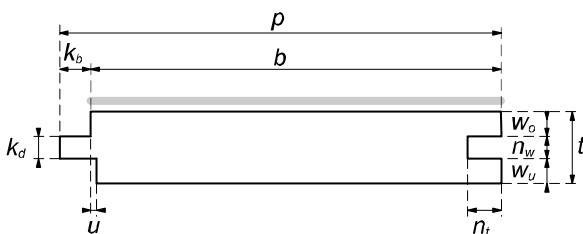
Section d'une lame de plancher rainée-crêtée (schématisée).
